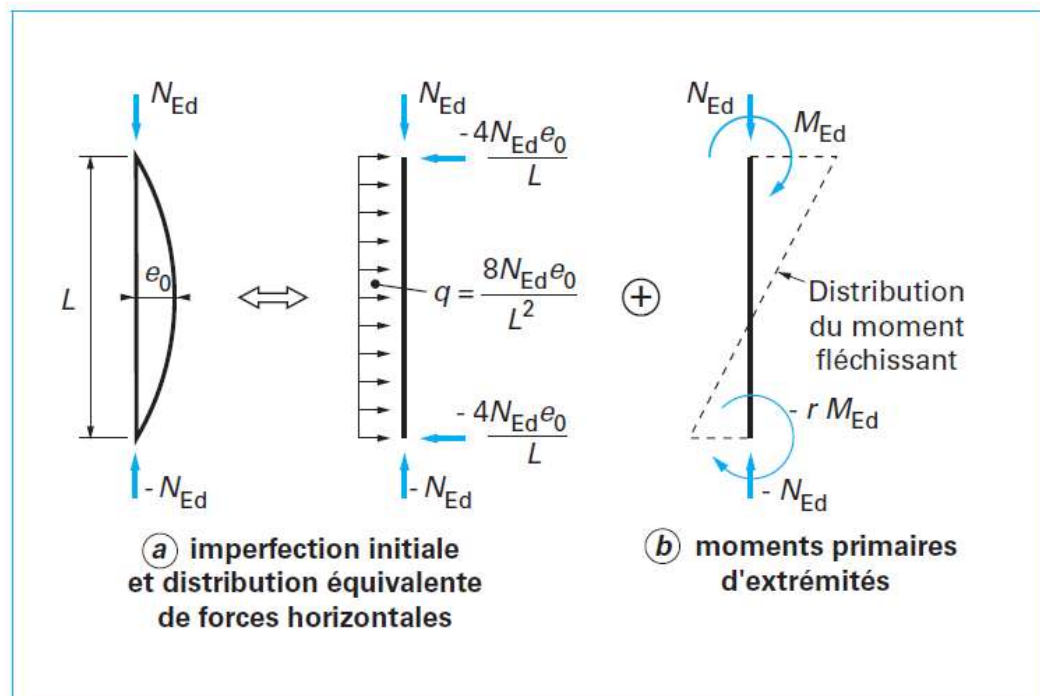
Exemple type d'actions primaires appliquées au poteau
